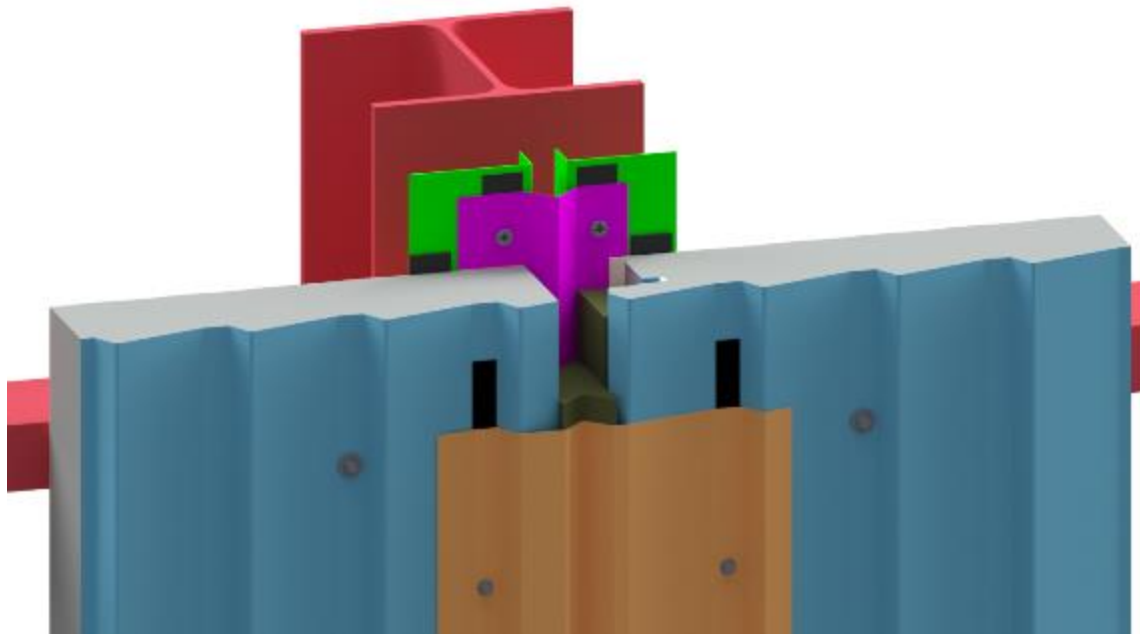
Exemple de baie avec panneau sandwich isolant Louvre en pose horizontale
